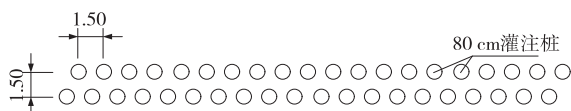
海塘提升方案二密排灌注桩支挡平面布置示意图(单位:m)
